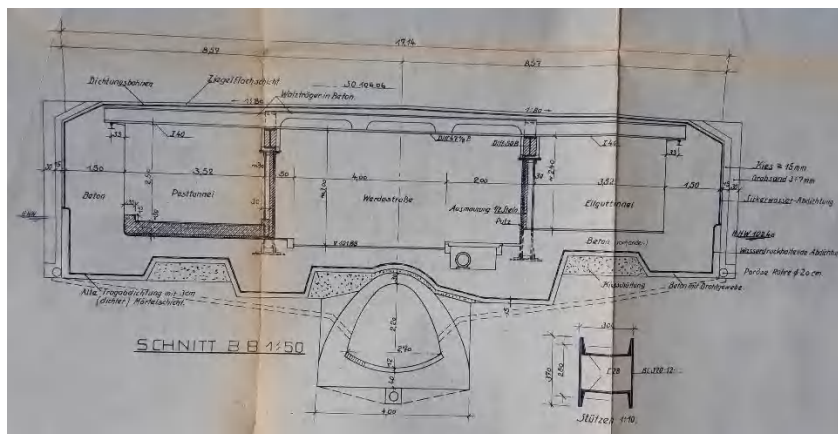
Auszug Querschnitt aus dem Bauwerksplan EÜ Werdestraße [DB Netz AG]
